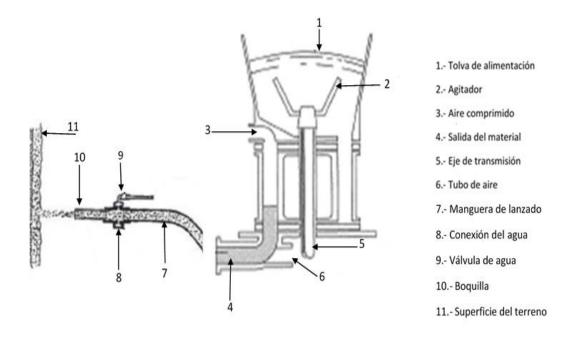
Diagrama de equipo de lanzador vía seca. (Dibujo de Shotcrete Practice in Underground Construction)
